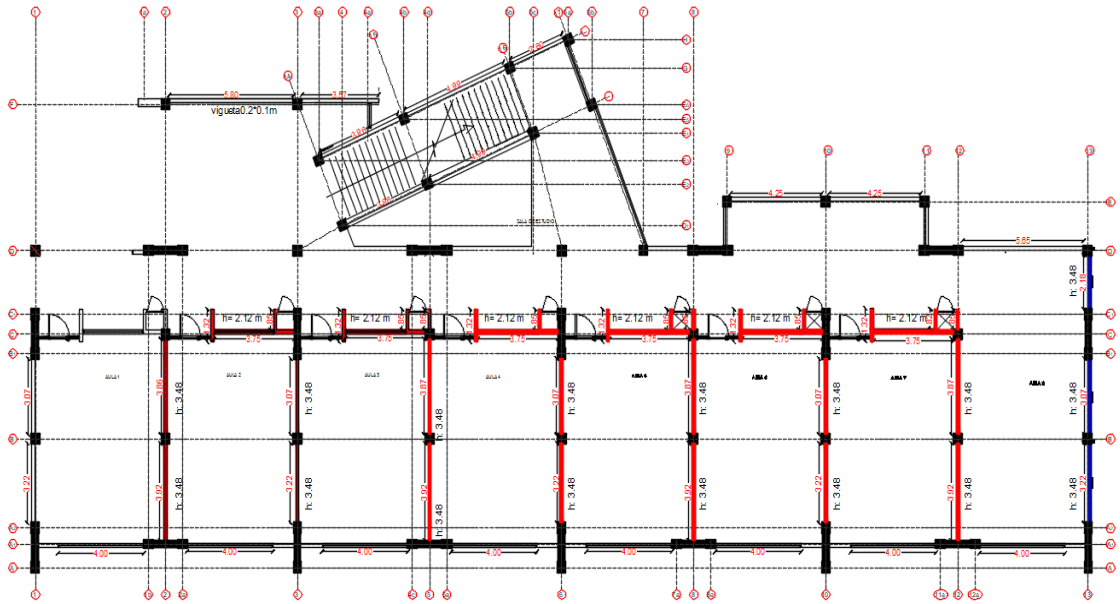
Planta de distribución del repello AUTOCAD – fuente propia
